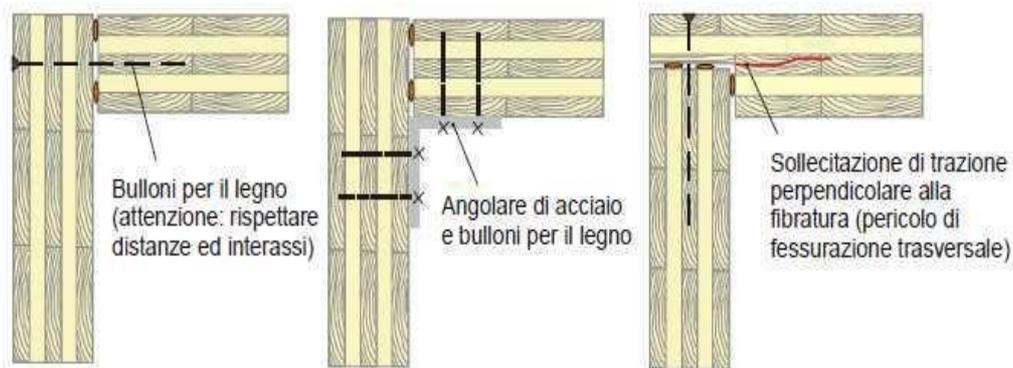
Giunzione parete-parete, possibilità di realizzazione del collegamento d'angolo mediante bullonatura.
